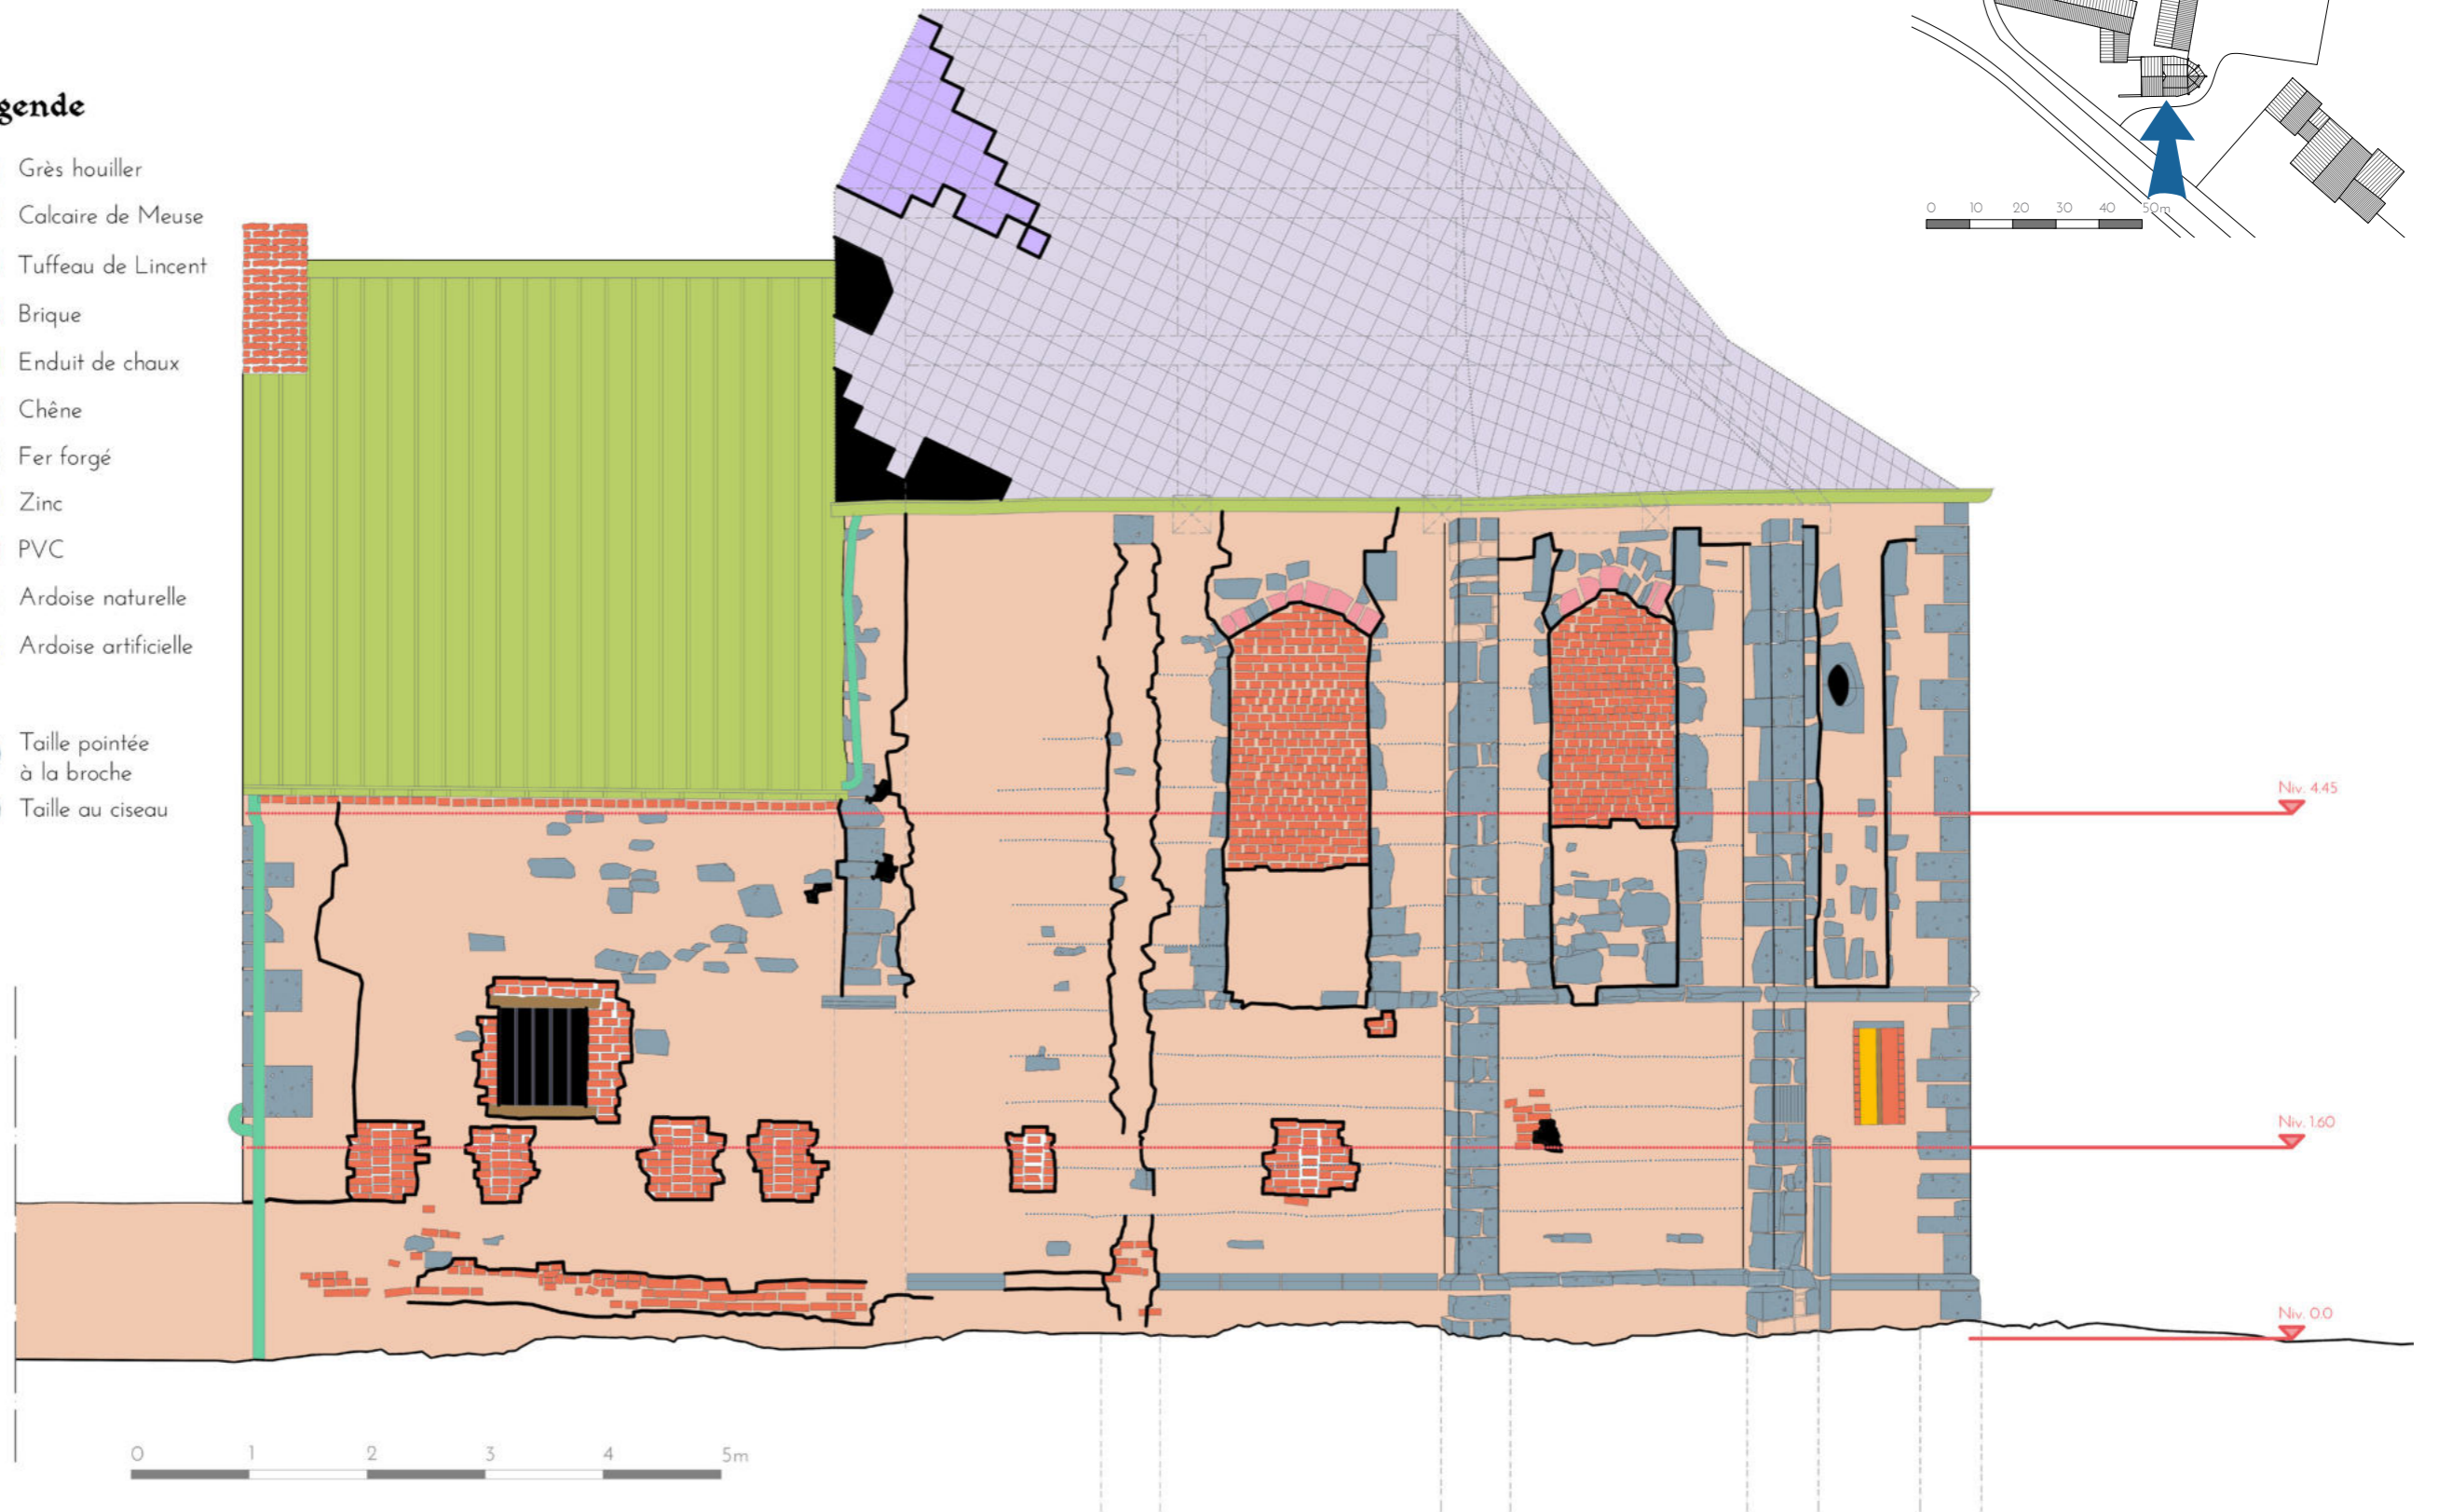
Elévation illustrant les matériaux employés. Façade sud.
